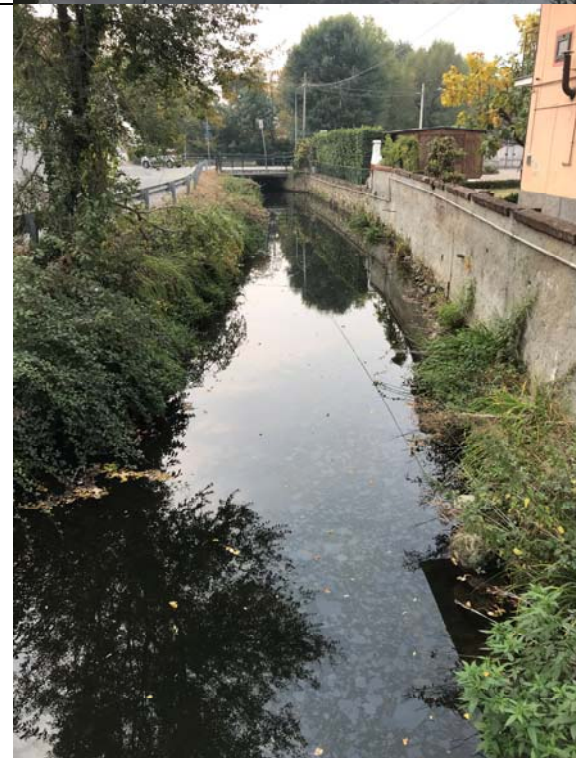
Vista dall'attraversamento privato del tratto del Rio Sangonetto oggetto di intervento.
